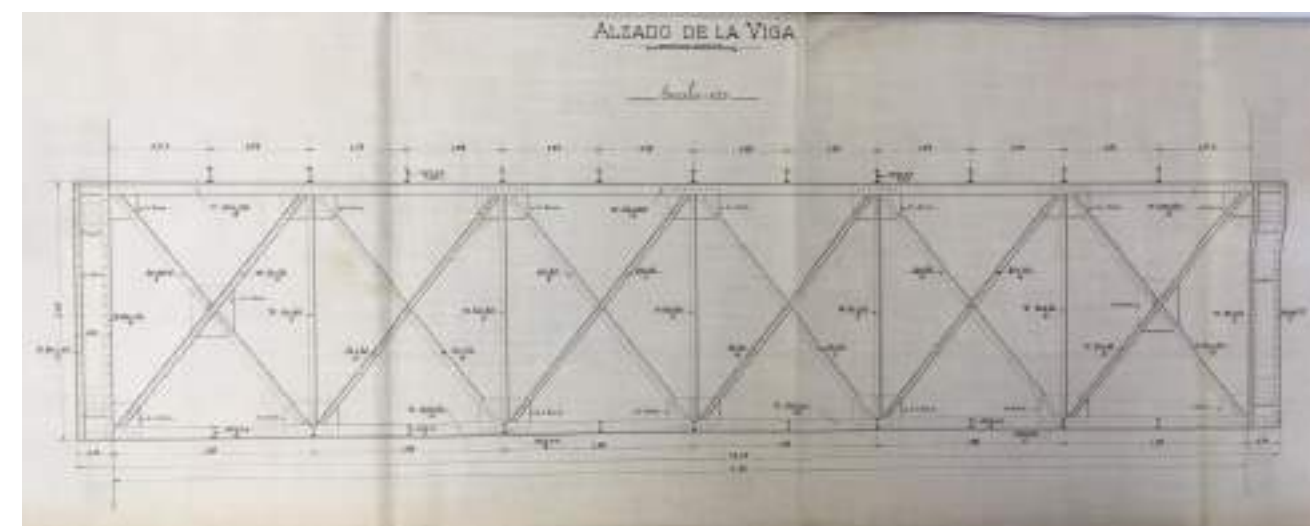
Vigas para la cubierta del pabellón central (Escala 1:20), “Proyecto de entramado metálico para la cubierta del Pabellón Central del Edificio de Viajeros”, 1907. AHF-MFM. B-0057-006 6/16.
